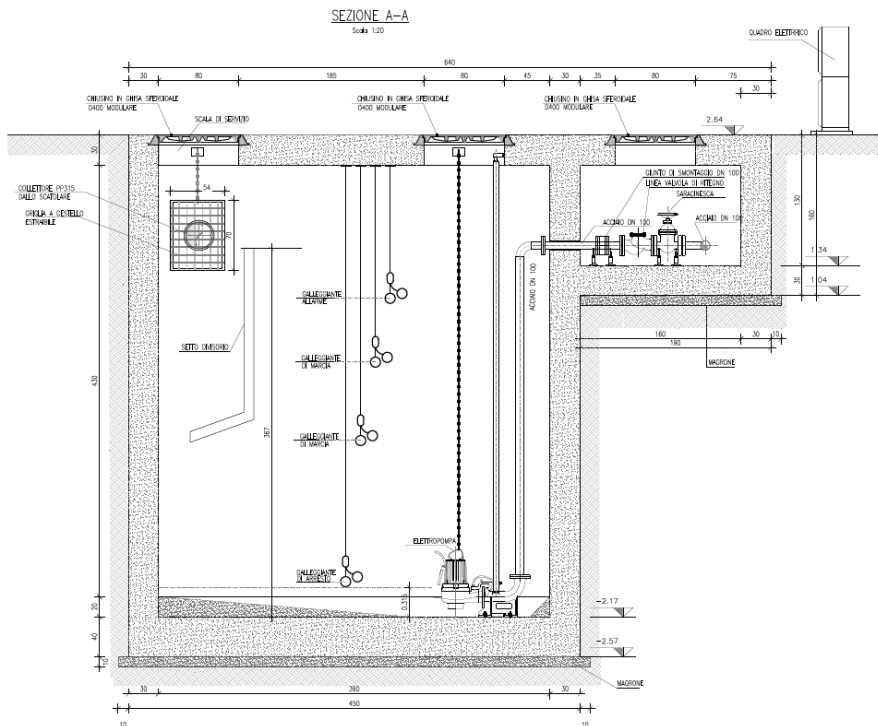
Impianto di sollevamento NV01 - sezione A-A
